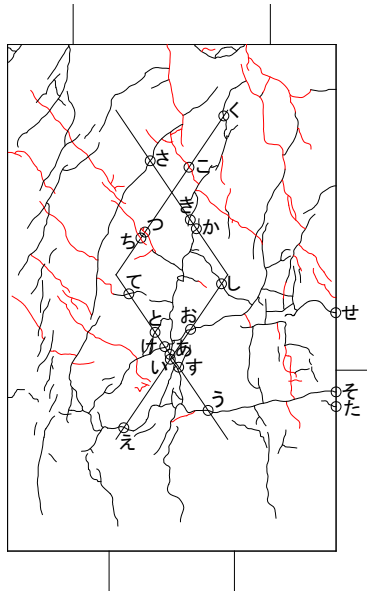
パイルキャップひび割れ幅測定位置(試験体 A-7a 正載荷)
